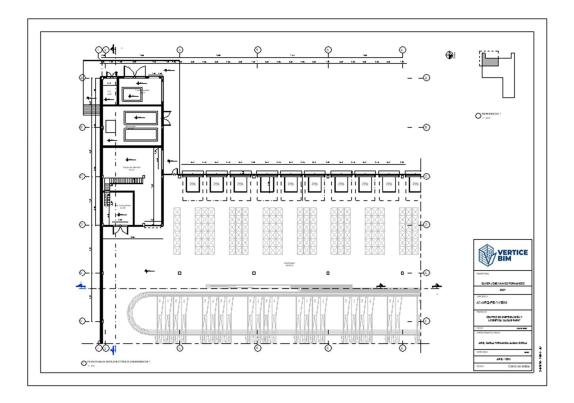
Planta arquitectónica del proyecto Aloag-Park.
